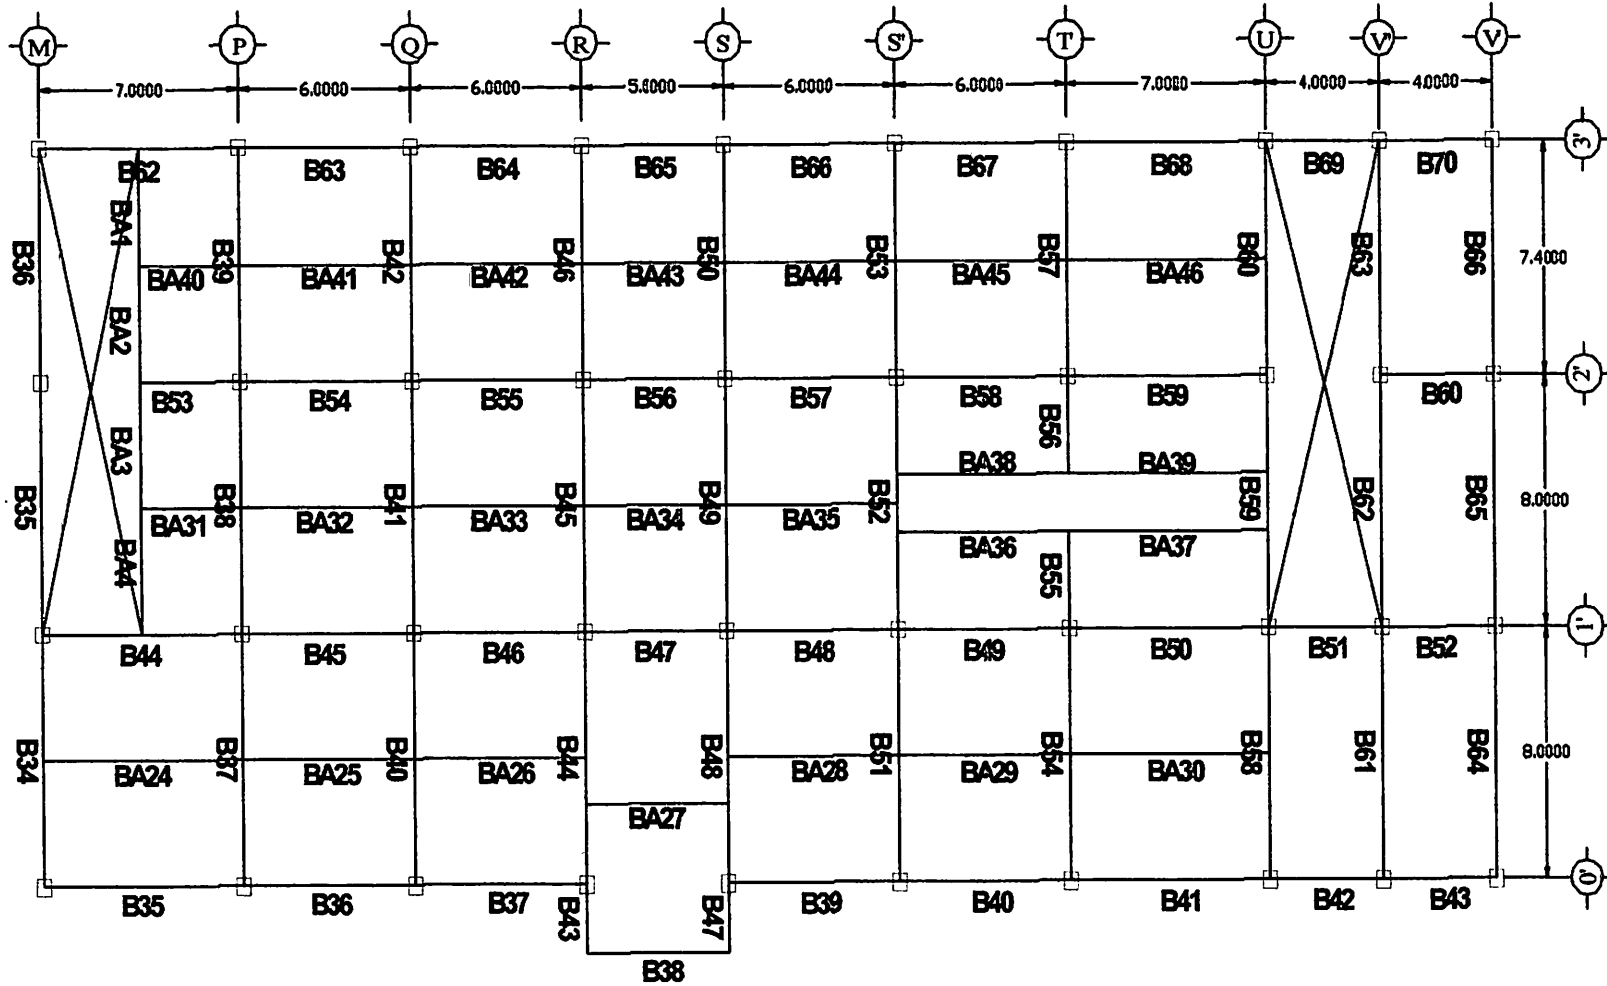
Denah Pelat Lantai 3 Parkir
